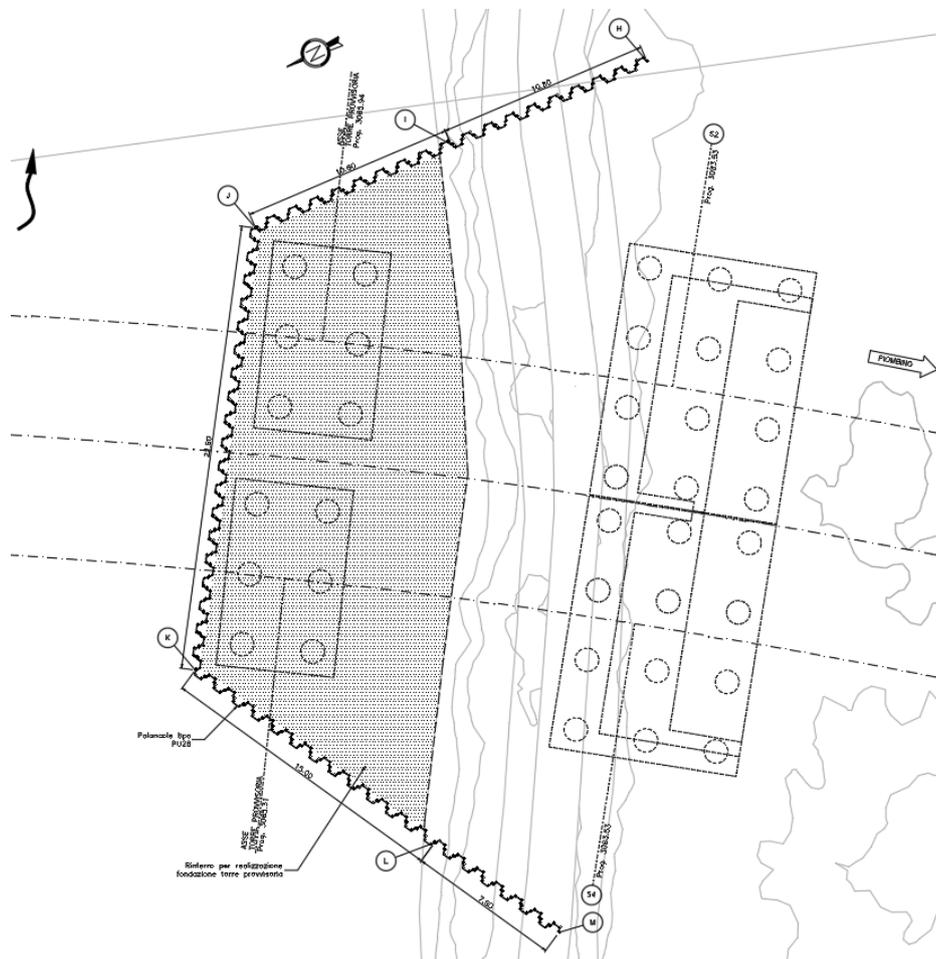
Vista planimetrica delle opere provvisionali previste in corrispondenza delle spalle S2 e S4.
